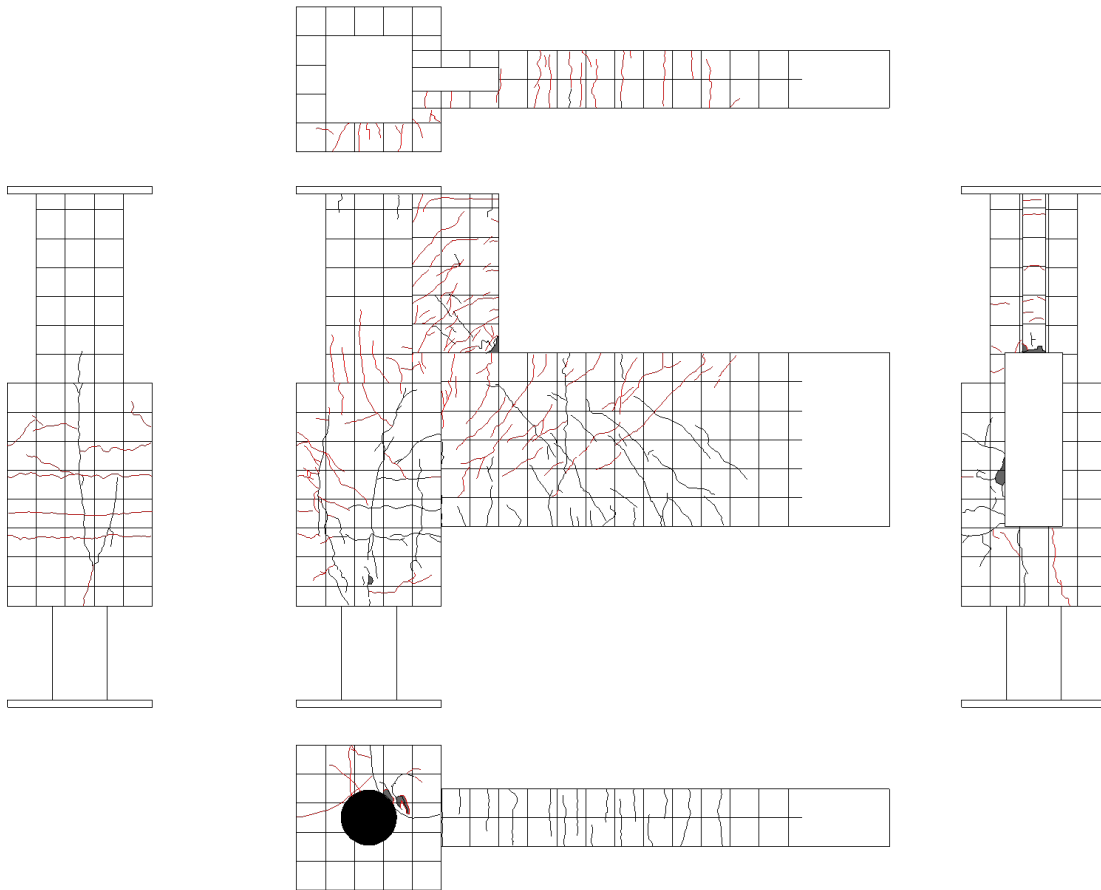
試験体 B-1 ひび割れ状況 (6Cycle)
